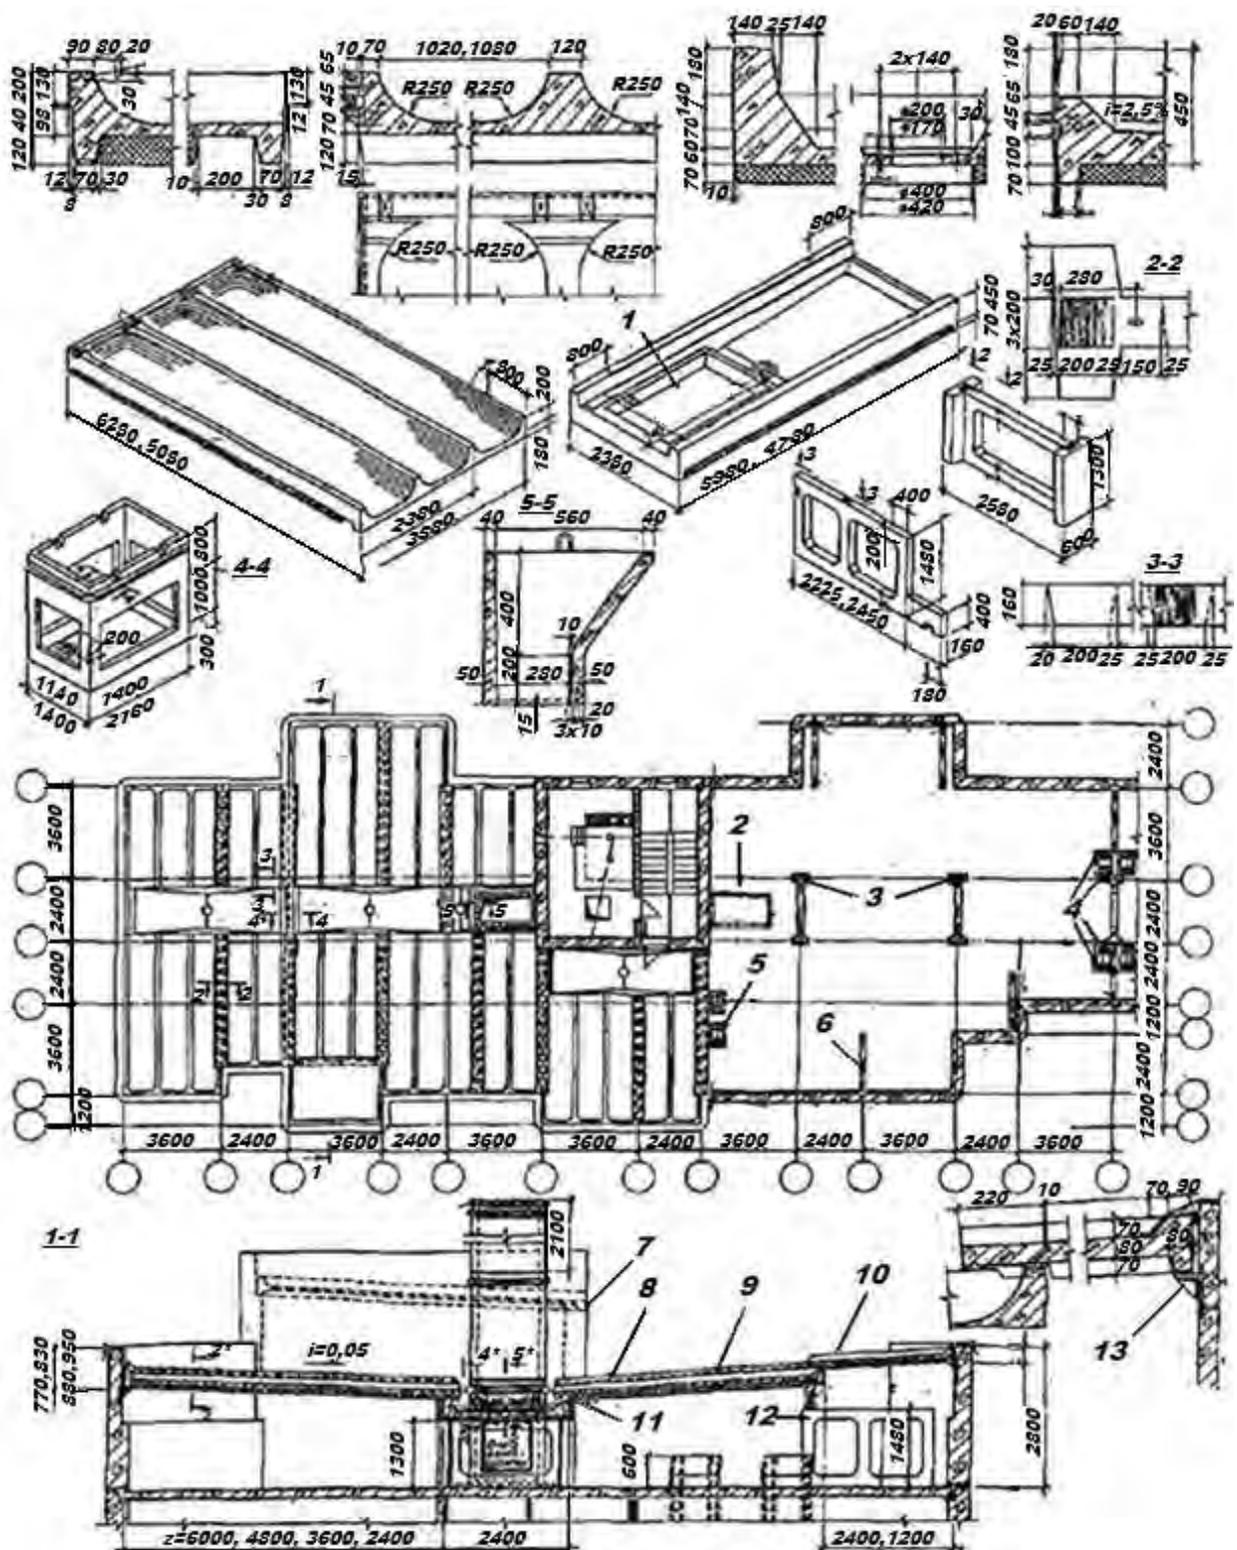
Полносборная крыша из железобетонных плит с безрулонной кровлей над теплым чердаком панельного здания с внутренним водостоком: 1 — отверстие для вентиляционной шахты в левой части лотка; 2 — окна вентиляционной шахты; 3 — несущие стены; 4, 5 — диффузоры; 6, 12 — контрфорсная стена; 7 — машинное помещение лифта; 8 — парапетная плита над стыком; 9 — ребристая кровельная плита; 10 — доборная кровельная плита 2580 × 3580; 11 — лоток; 13 — опорный столик из уголка 100 × 10
